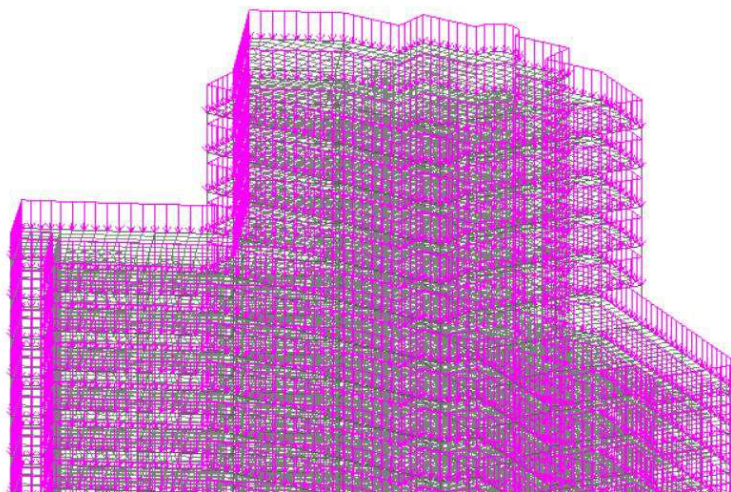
Нагрузка от фасадного остекления (по всей высоте здания)
